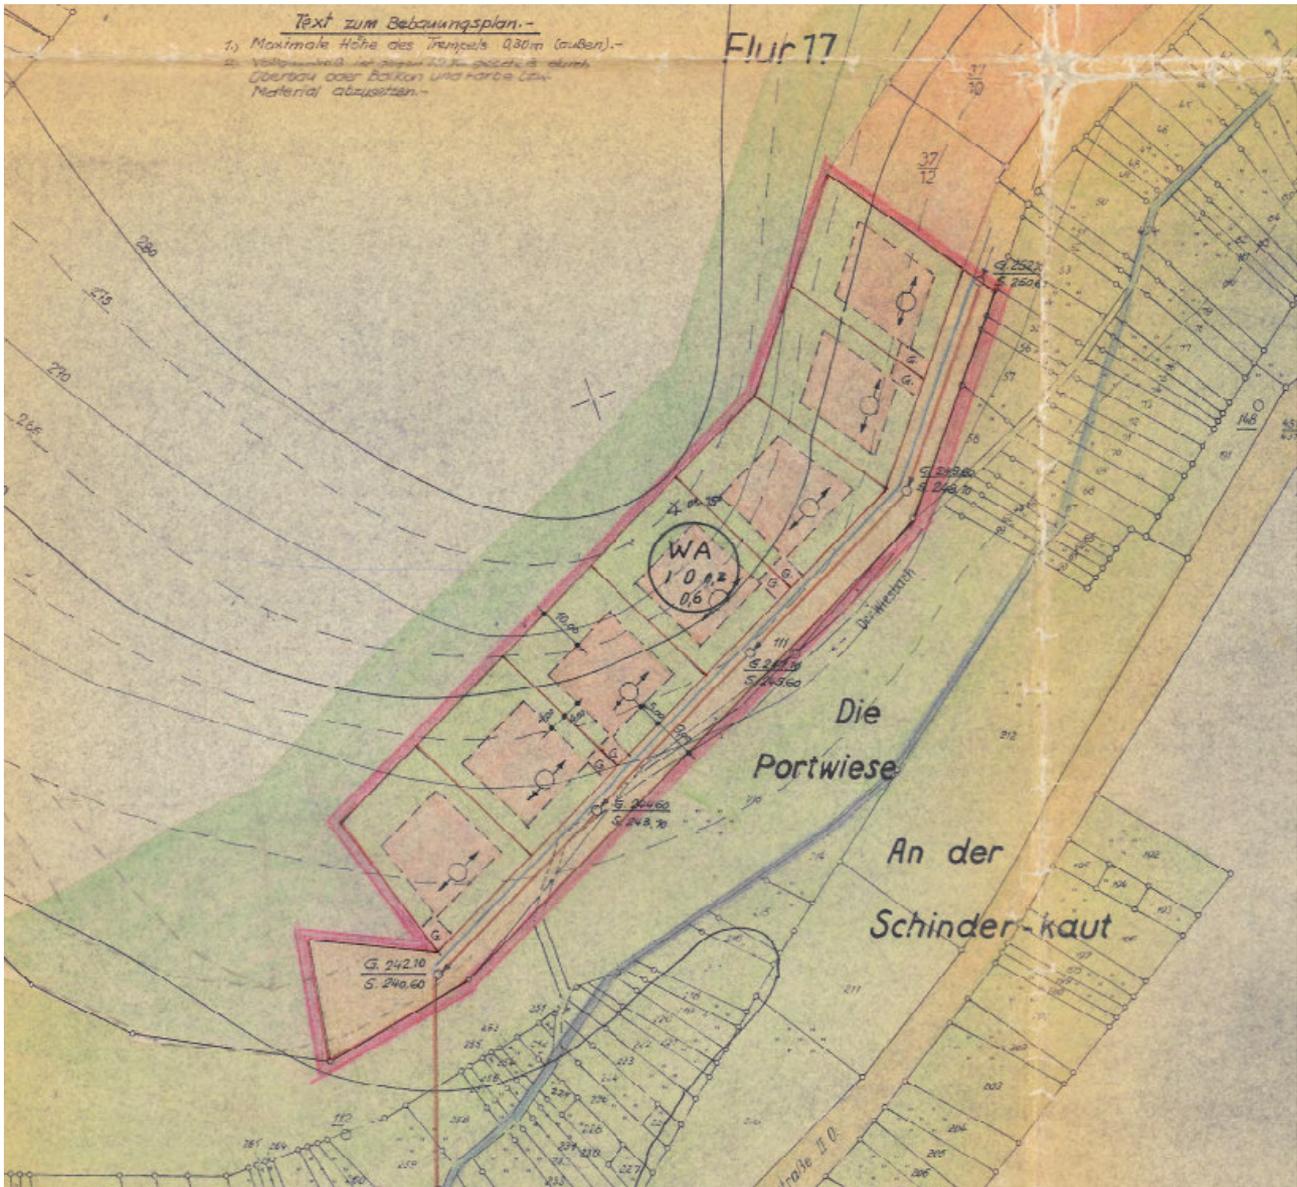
ursprünglicher Bebauungsplan, nur Planzeichnung, nicht genordet
